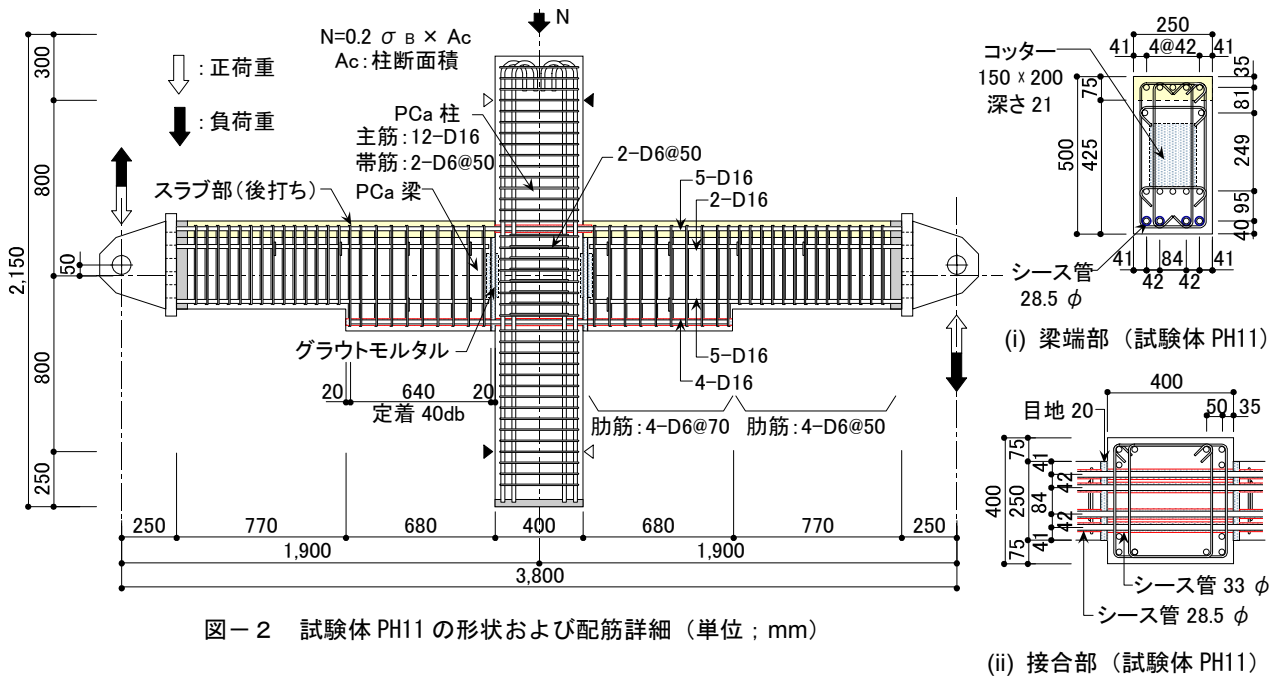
試験体 PH11 の形状および配筋詳細 (単位 ; mm)
